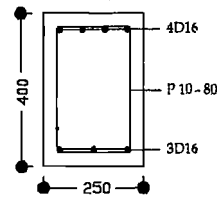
Detail Tulangan Balok Induk BA2 As K' Lt 3
